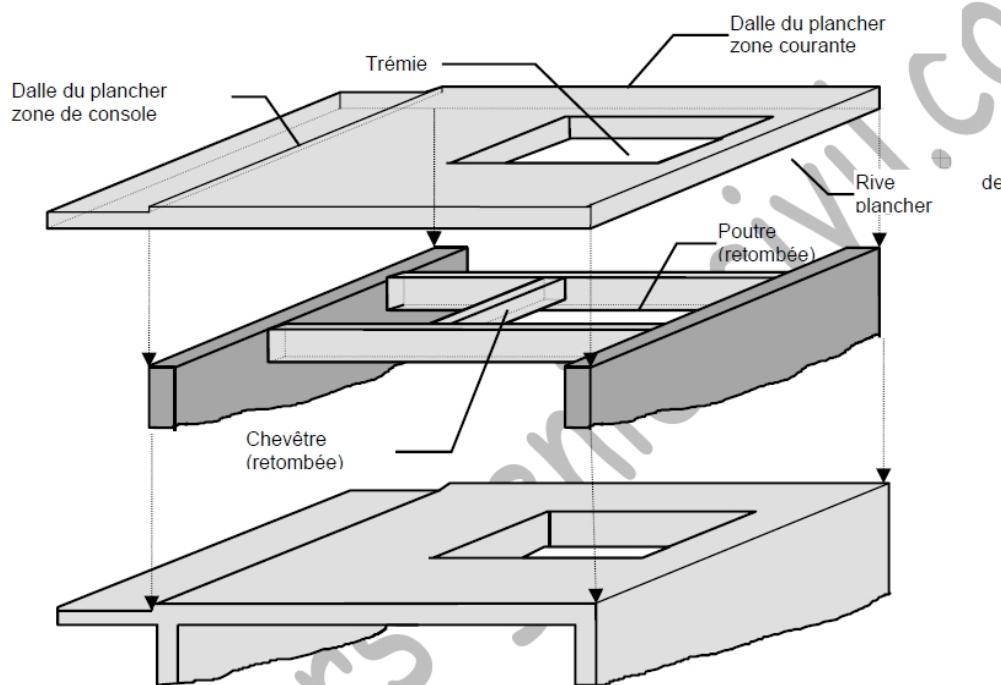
un réseau porteur horizontal constitué de poutre, poutrelles et chevêtres
